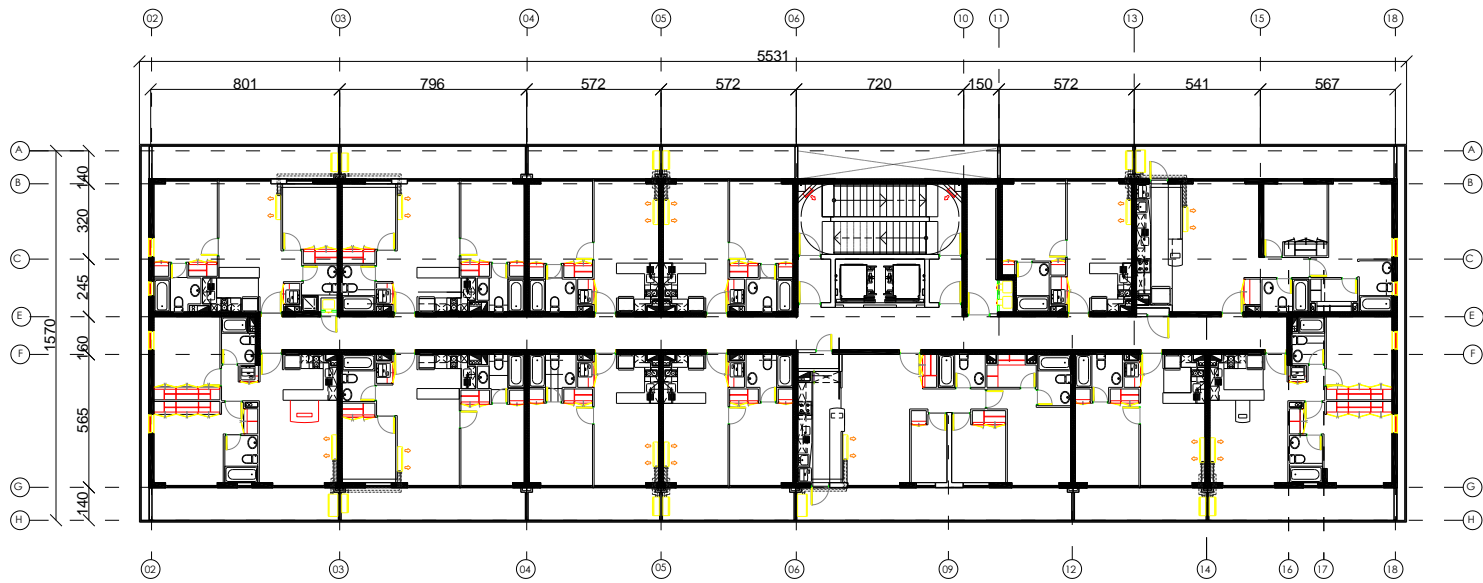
Planta de arquitectura de nivel tipo Edificio Torre del Sol (Revista AICE, 2012) [7].
